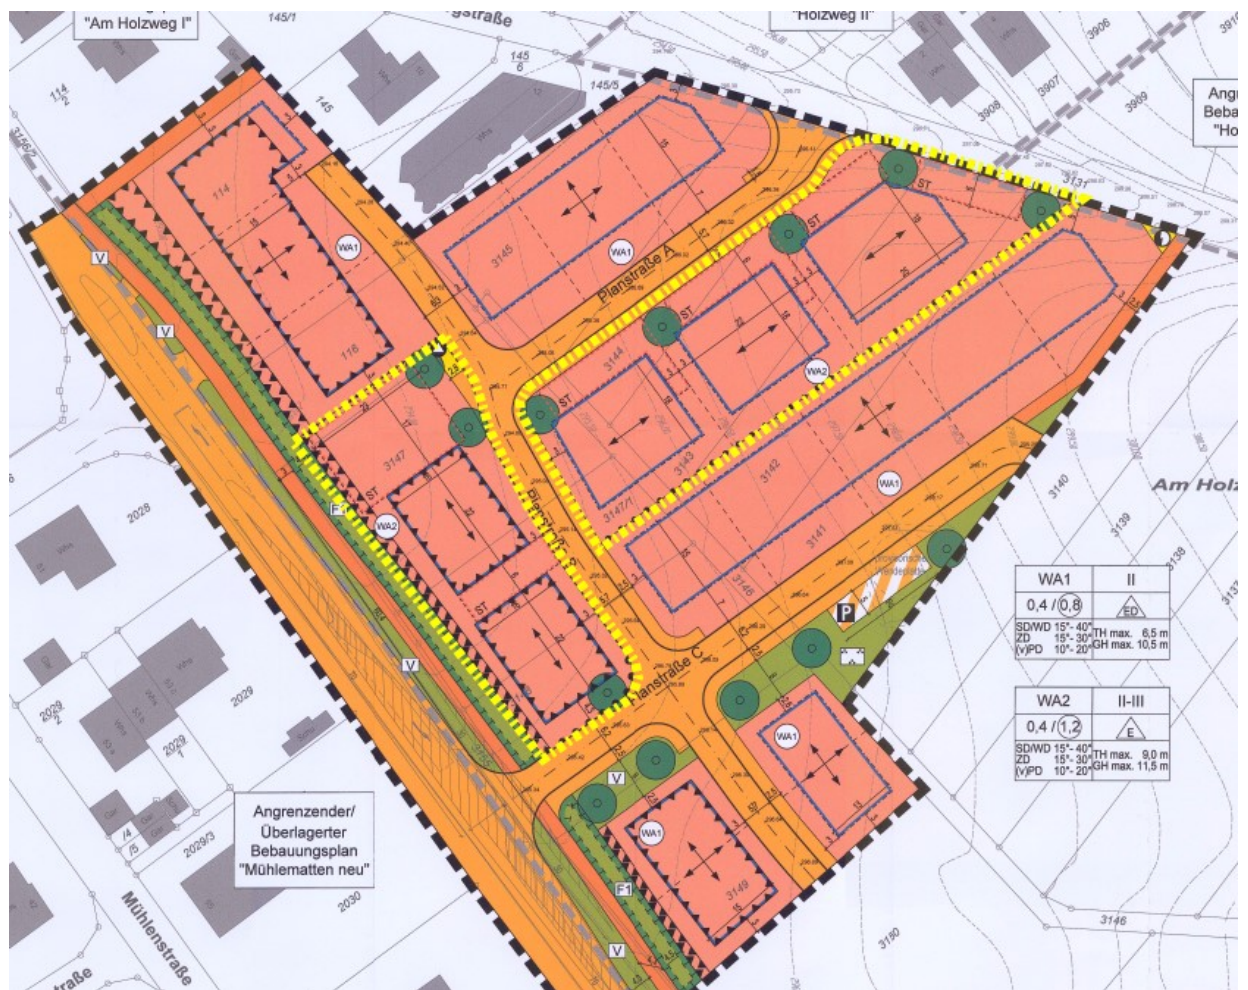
Zu prüfende Baufenster des Bebauungsplans am Holzweg IV (gelb umrandet)
